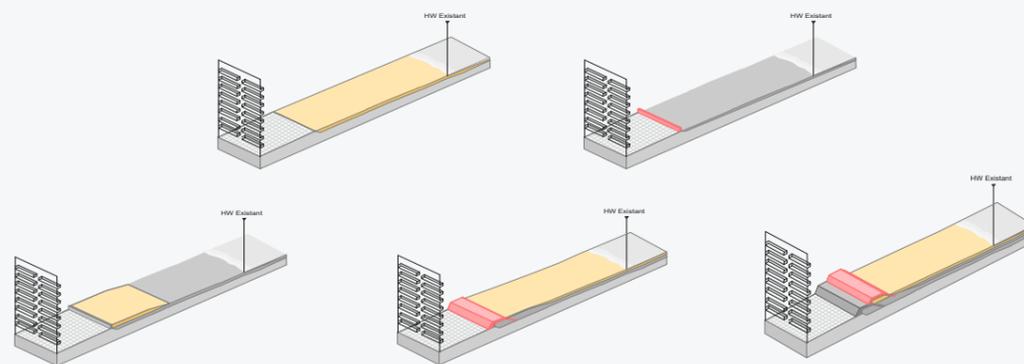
Principe d'élévation progressive des berges et de la plage dans les stations balnéaires pour l'alternative "sur place". La ligne des hautes eaux est indiquée sur les figures par HW.
